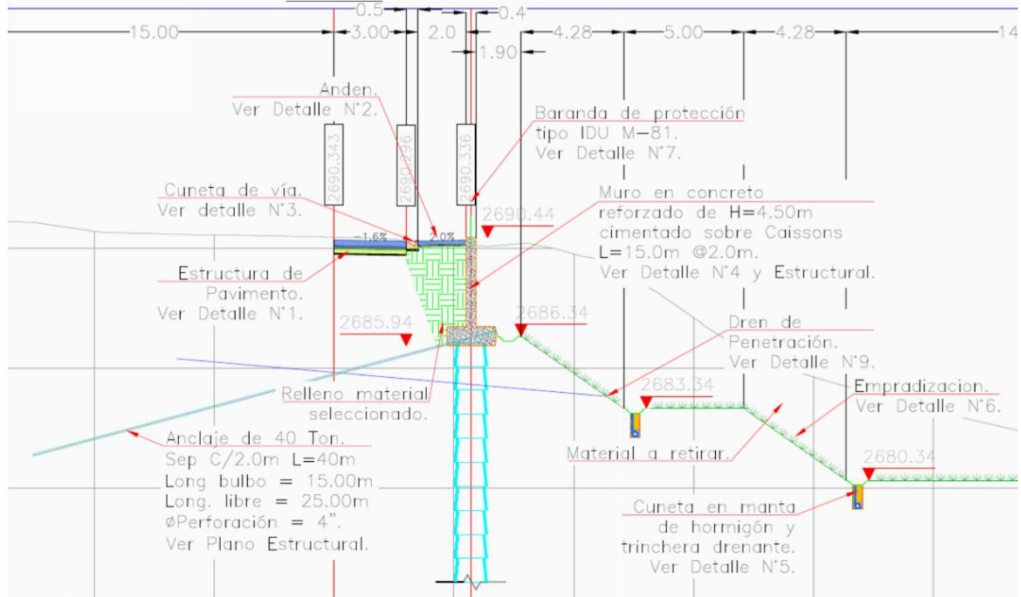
Perfil típico de diseño para la estructura de estabilización.
